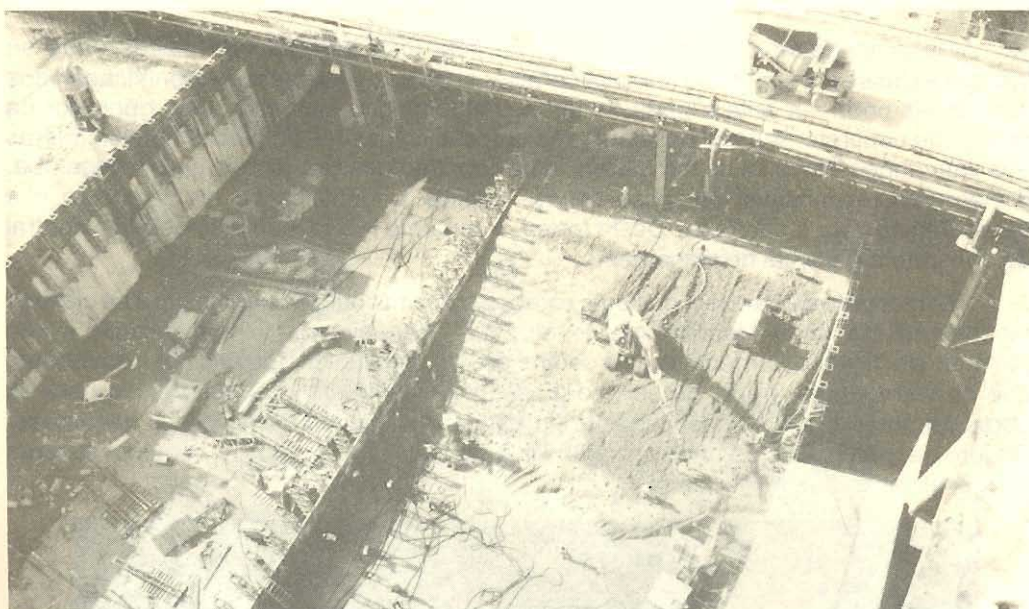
Colocação do concreto com dumpcrete e espalhamento com trator de lâmina - Tucuruí
